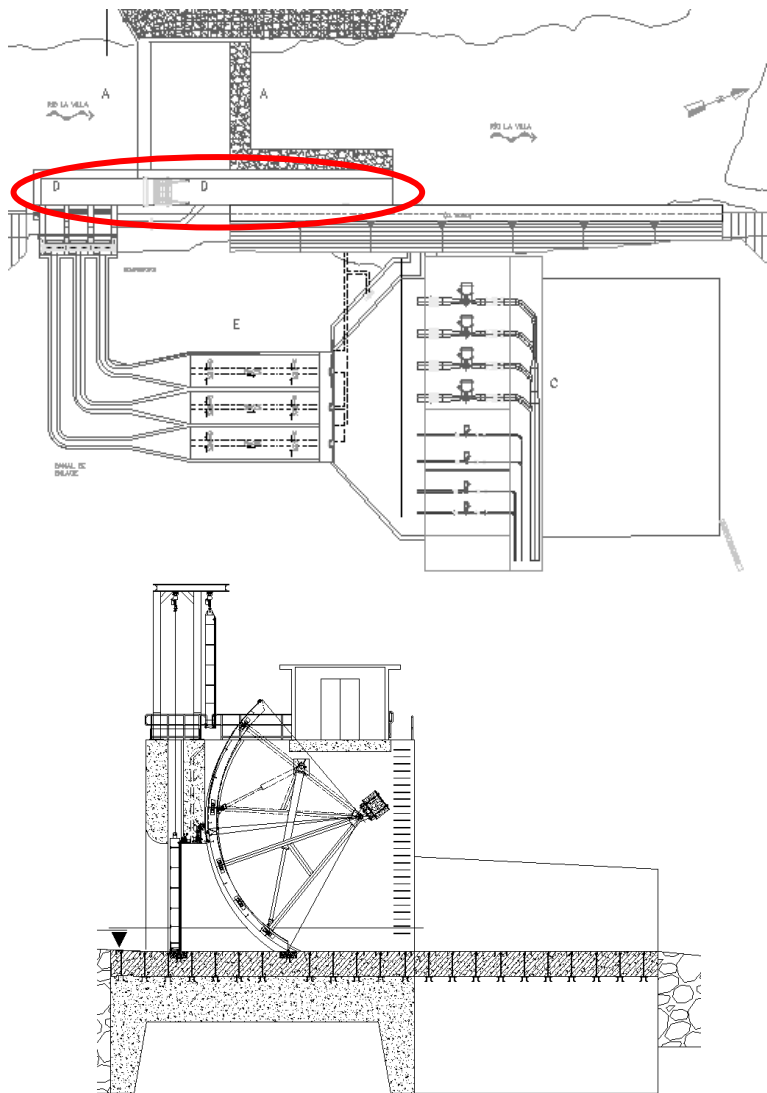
Localización en planta y Corte Longitudinal Canal de Limpia El Gato
